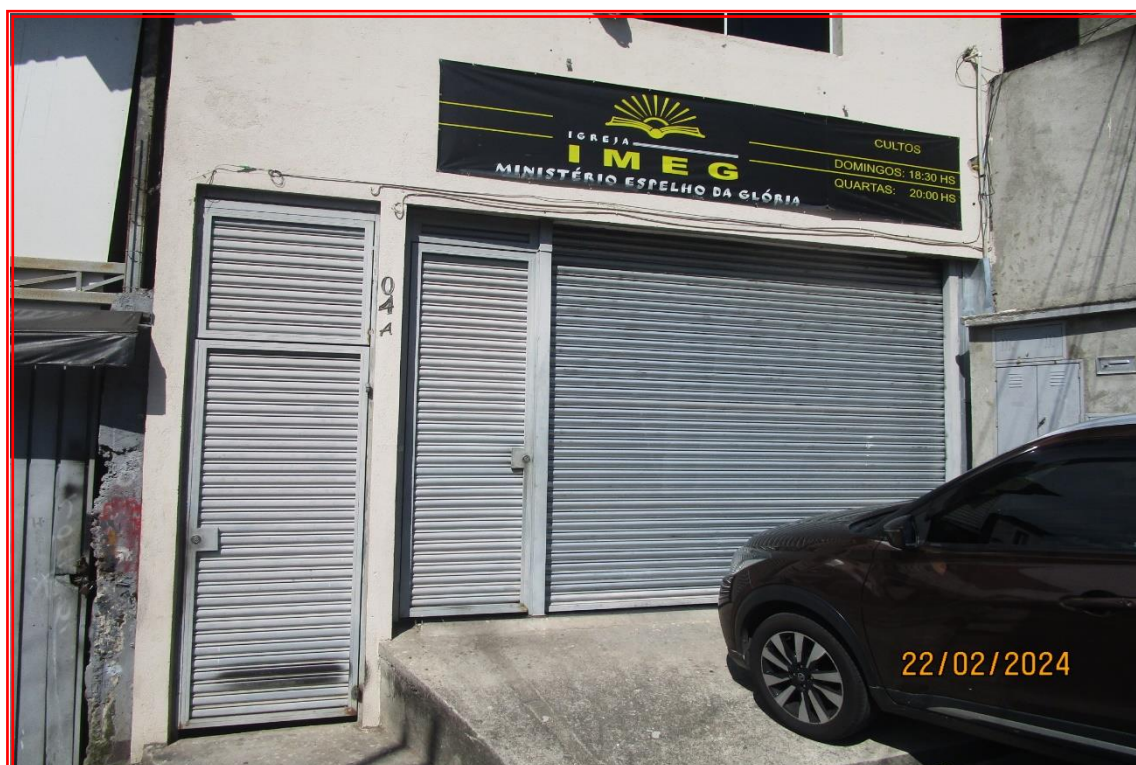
Vista do portão de acesso aos pavimentos subsolos e superiores, com detalhe para o salão do térreo alugado para uma instituição religiosa.
